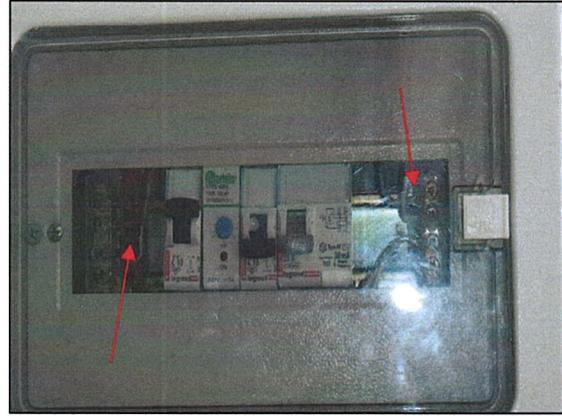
, falta tapa interior en tablero eléctrico torre H.
